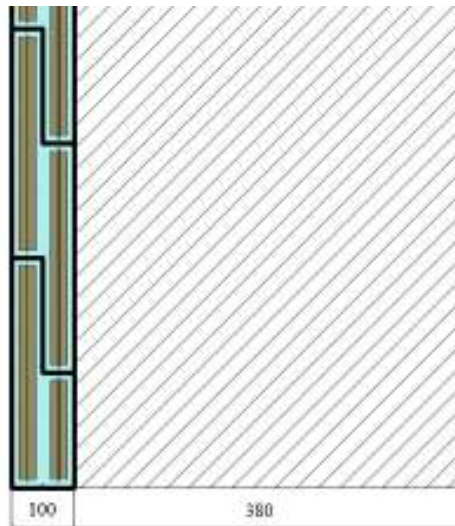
Стіна утеплена плиткою з невентильованими повітряними прошарками
